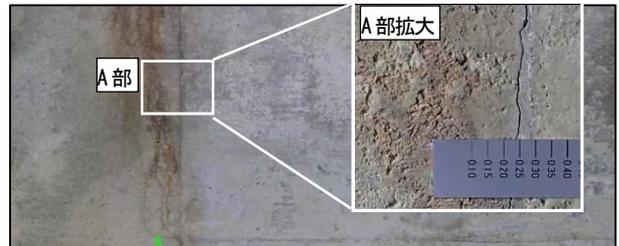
変色範囲に隠れたひび割れを認識しない事例
